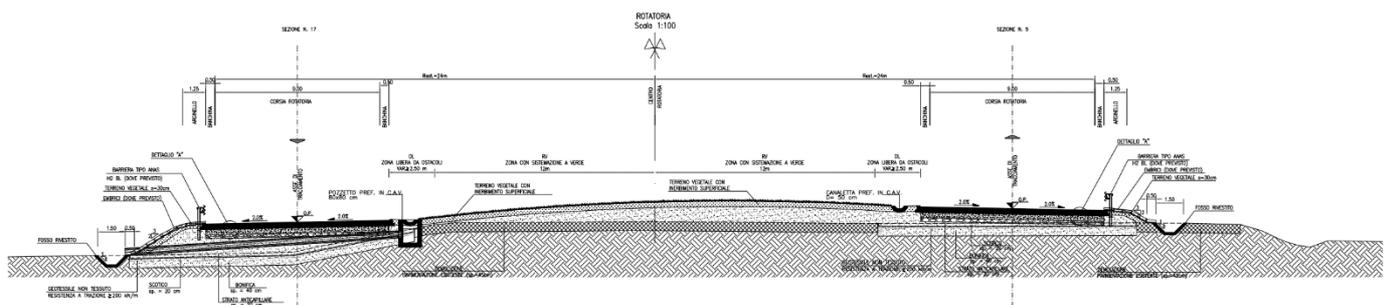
Sezione tipo: Ramo 1 (SR 105)
